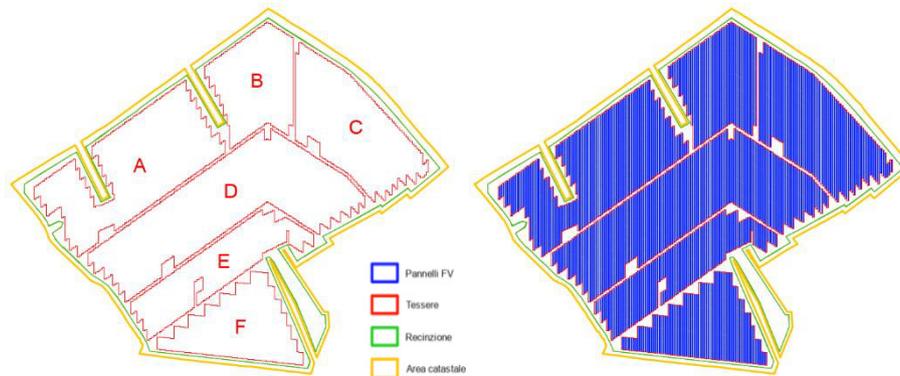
Suddivisione dell'impianto in 6 tessere⁷⁰.
